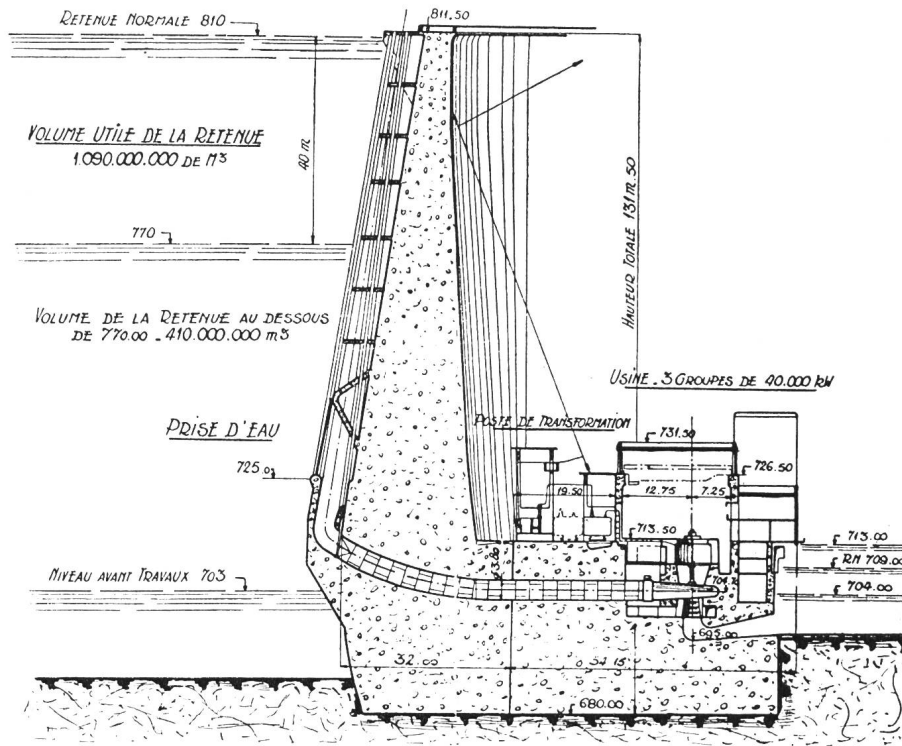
Coupe transversale du barrage et de l'usine de Bin el Ouidane
